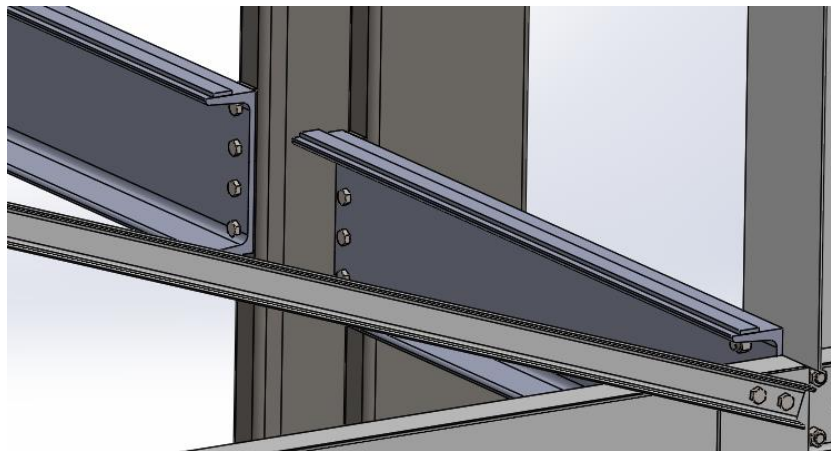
Ensamblaje columna plataforma superior y viga primer piso.
